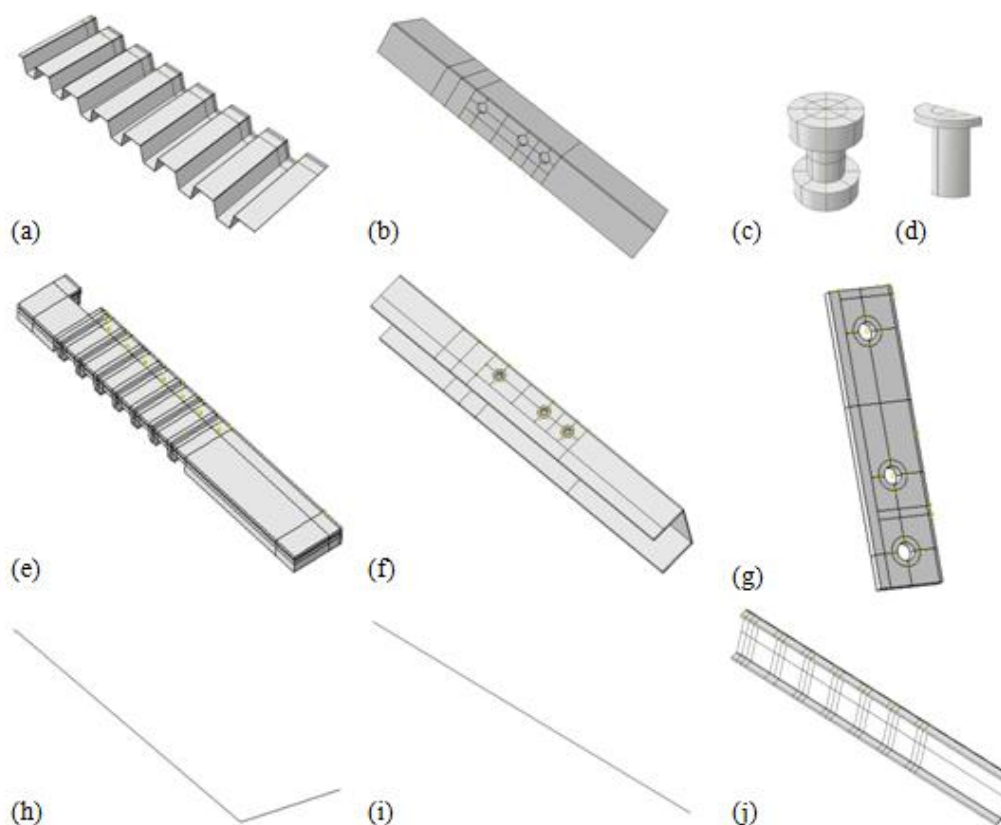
"Parts": (a) chapa colaborante; (b) betão entre os banzos; (c) parafuso; (d) conector; (e) laje de betão; (f) coluna metálica; (g) chapa de topo; (h) macaco hidráulico; (i) simulação da zona inferior e superior da coluna; (j) viga metálica.
